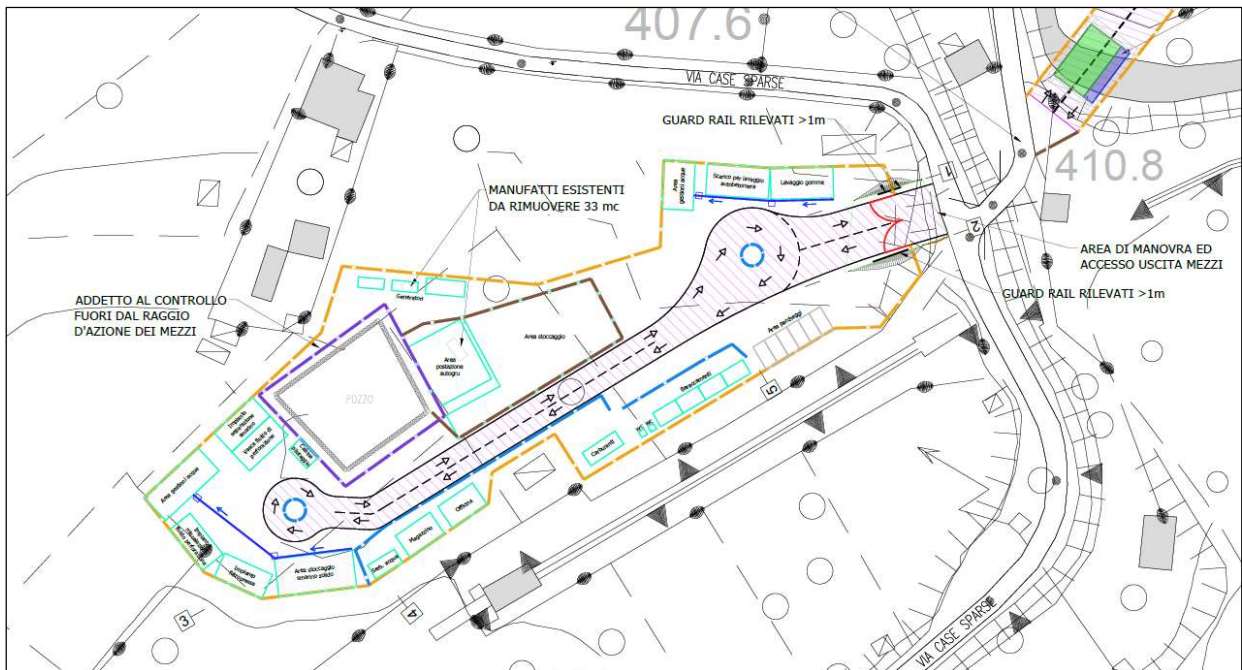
Area di cantiere M3 e Viabilità accesso
